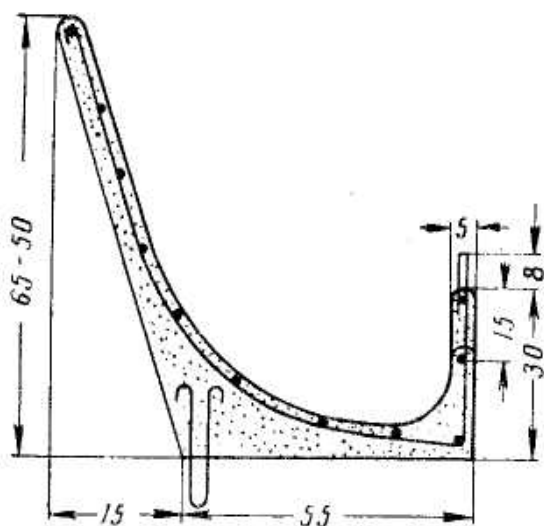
Поперечный разрез кормушки из железобетона для коров. Размеры даны в см.
